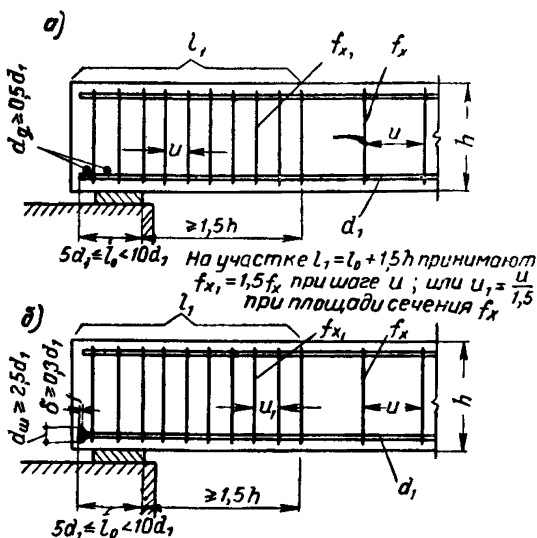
Анкеровка гладкой продольной рабочей арматуры в сварных каркасах на свободных опорах балок из бетона марки не ниже 200 в случаях,
